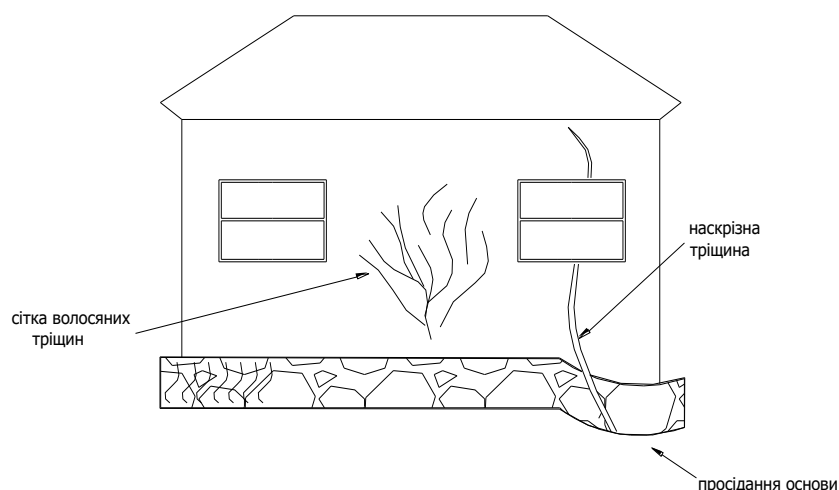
Пошкодження правого бокового фасаду будівлі
